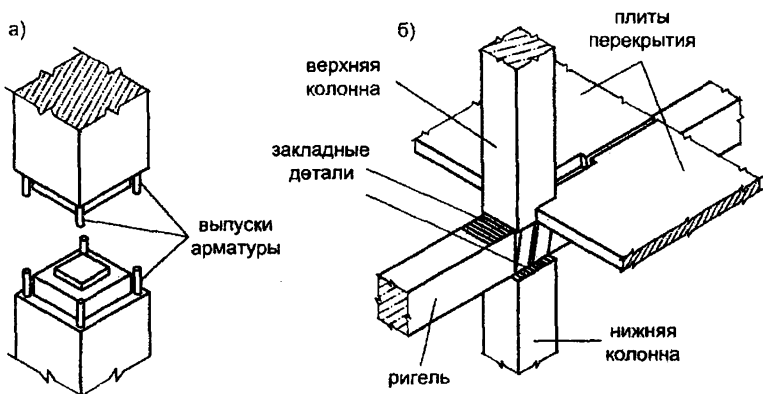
Стыки колонн: а – со сварным оголовком; б – платформенный
